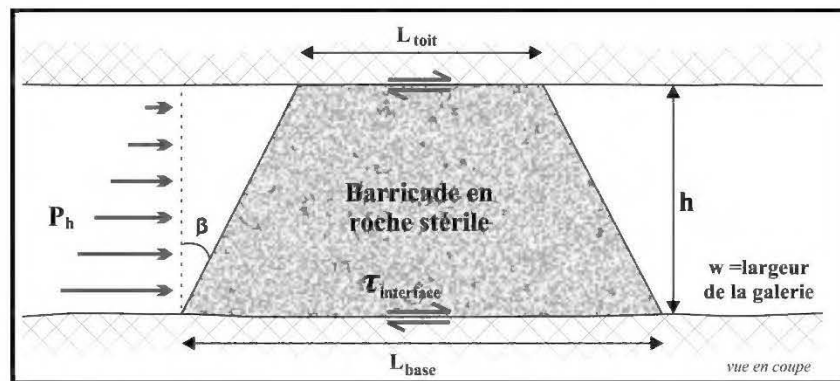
Coupe d'une barricade de roches stériles et les forces en jeu.
